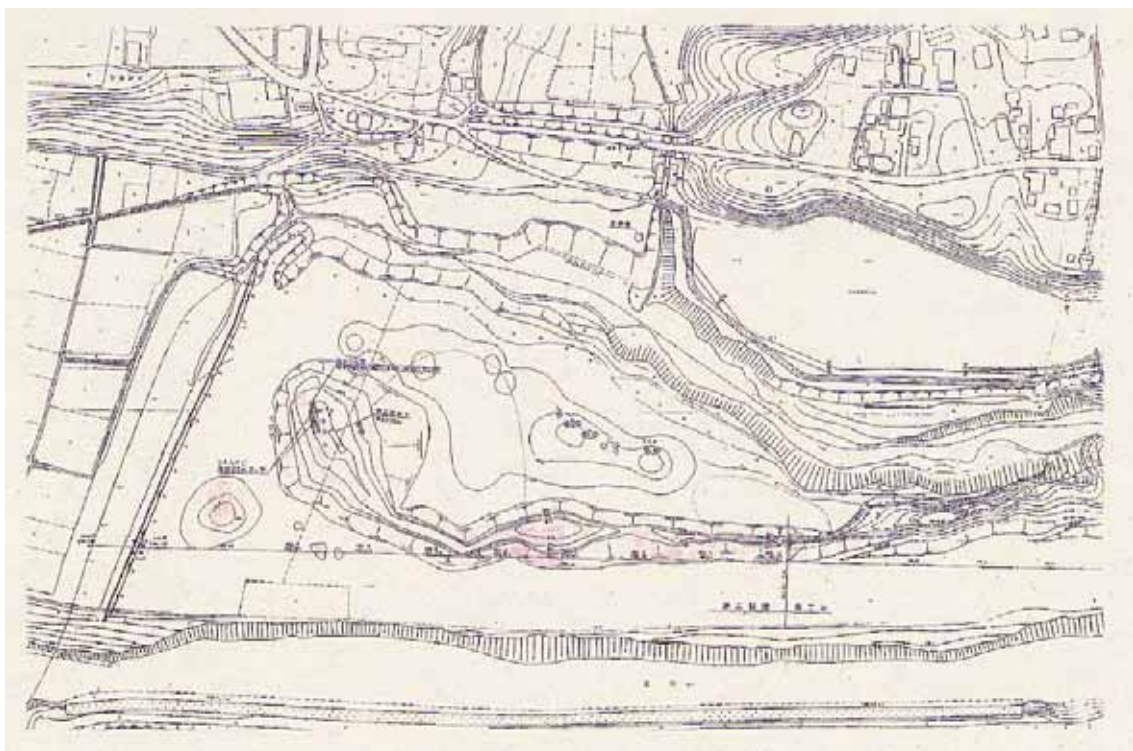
左岸整備平面図 (出典 : 荒川ピオトーブアブストラクト)
